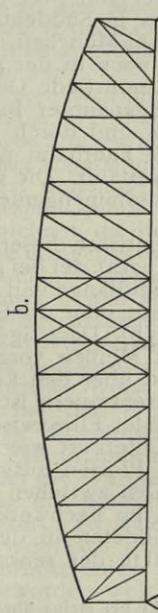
b. Halbparabelträger mit doppeltem Fachwerk.
